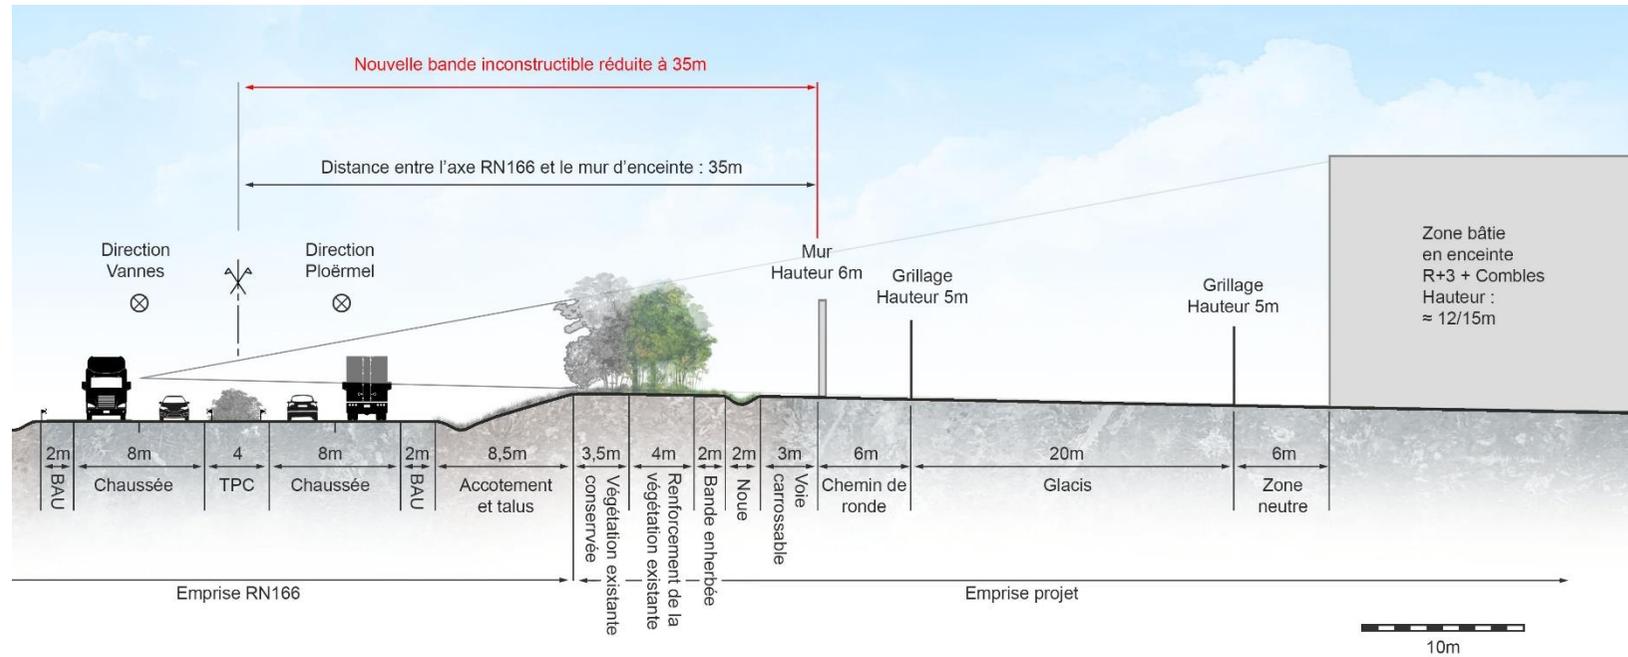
Coupe paysagère « recul de 35m » : nouvelle bande inconstructible avec préservation d'une partie de la haie arborescente
